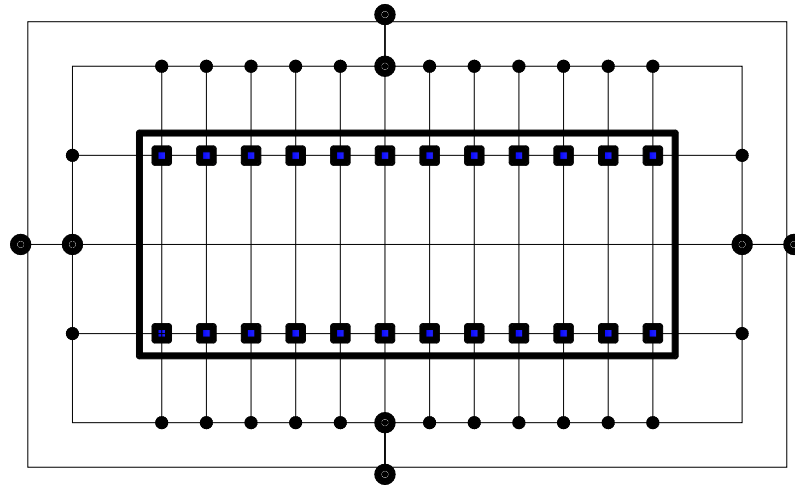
Схема закріплення головних і допоміжних осей промбудівлі:
